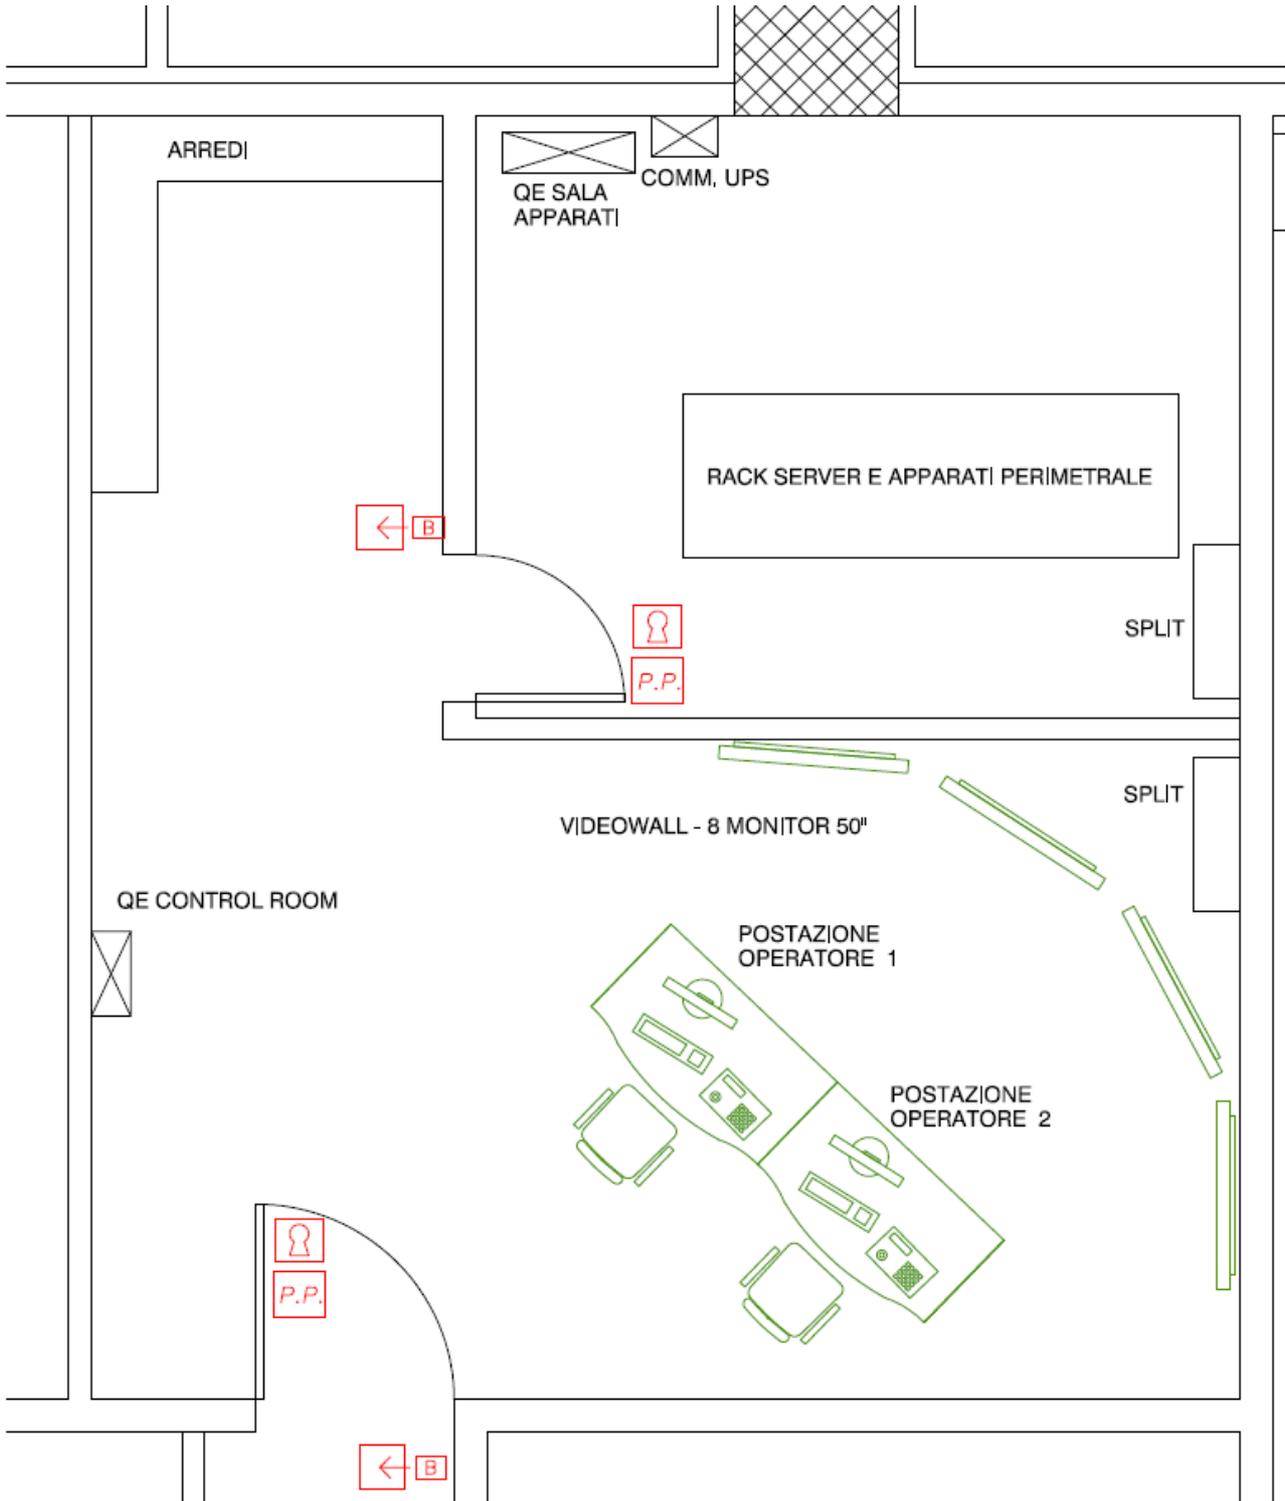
Control room – N.B. Il layout dell’allestimento è puramente indicativo.
